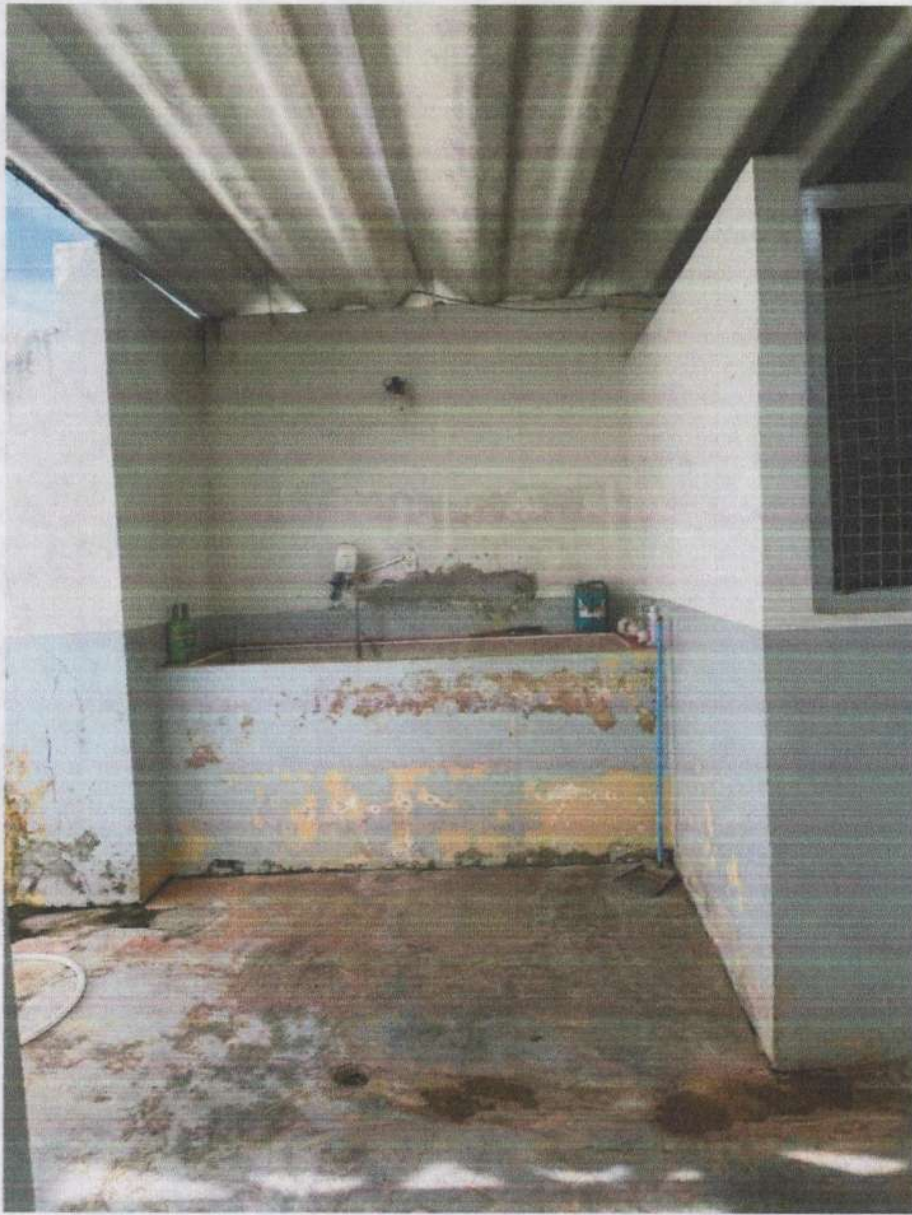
Cobertura com telhas onduladas (calhetão) com instalação inadequada e sinais de deterioração do ambiente com patologias de infiltrações generalizadas.
